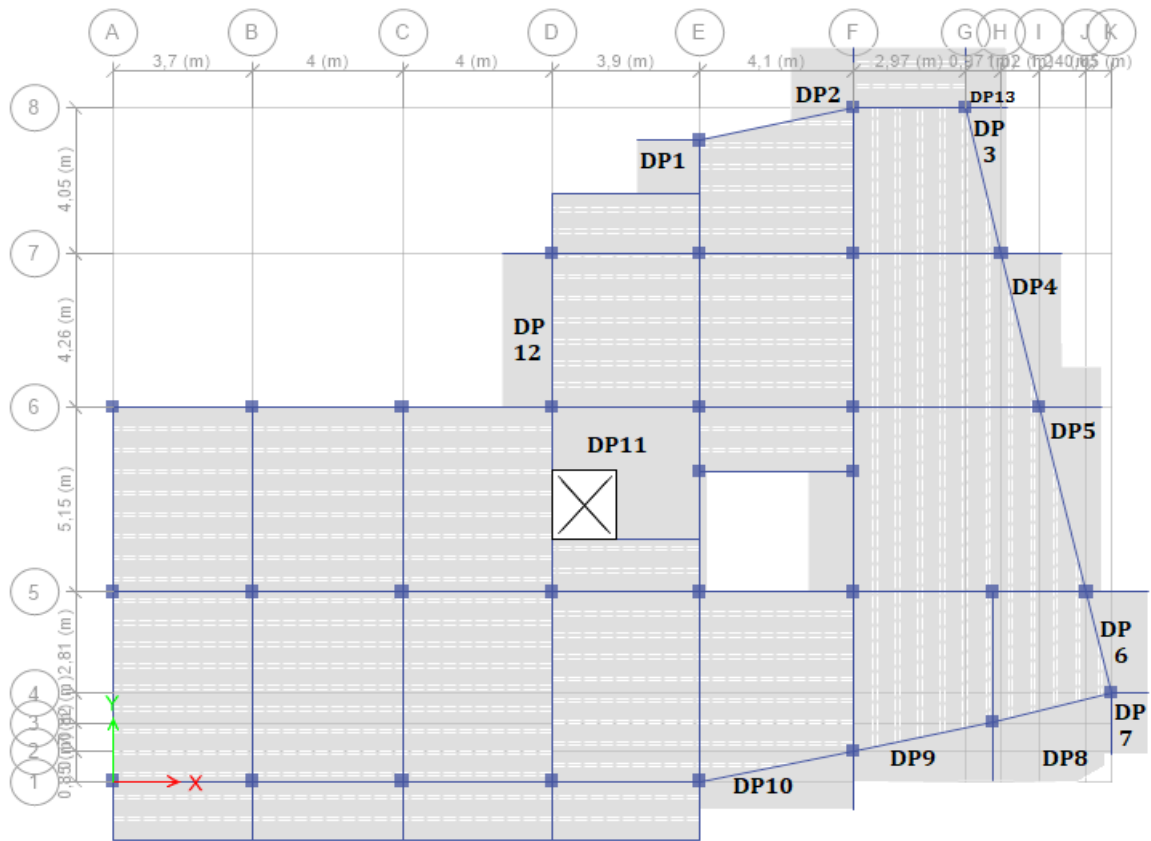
Plans de disposition des poutrelles aux différents niveaux.
